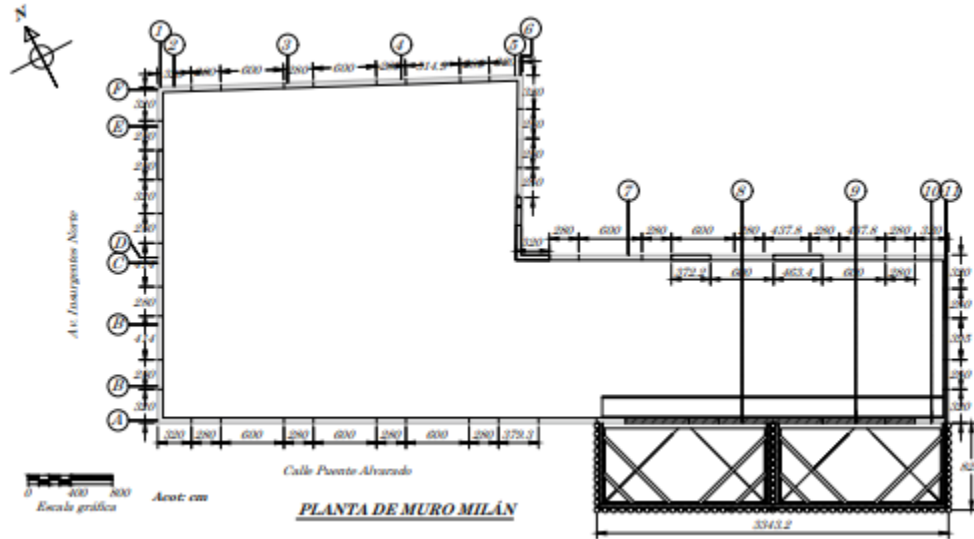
Solución propuesta para el rescate del muro Milán colapsado
